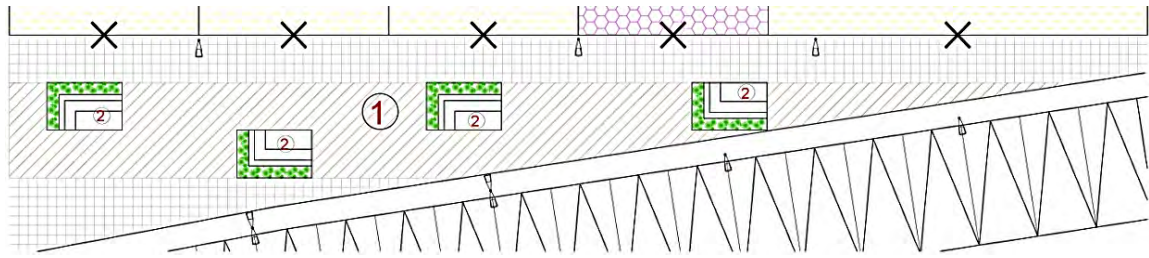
Planta de la plaza 16. Representado con líneas diagonales el acabado deck y con cuadrícula se representa la pizarra.
